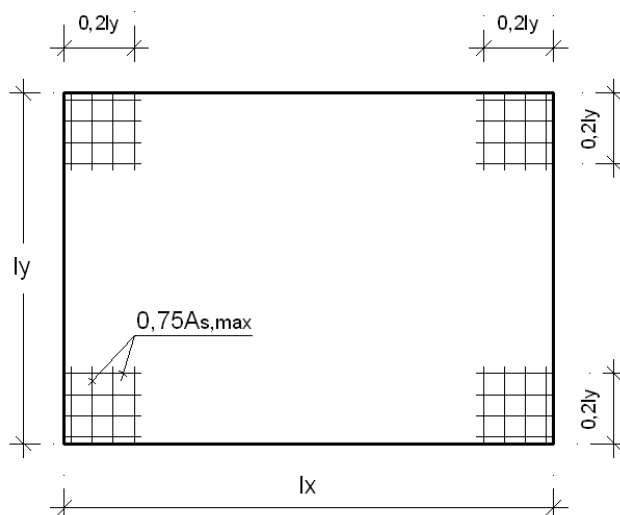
Armaduras de canto (camadas superior e inferior)
